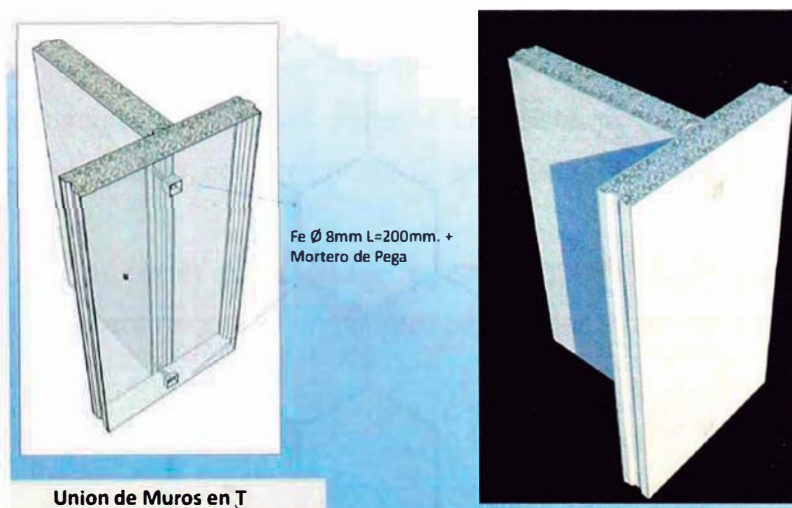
Detalle de colocación y anclajes en un encuentro en T
